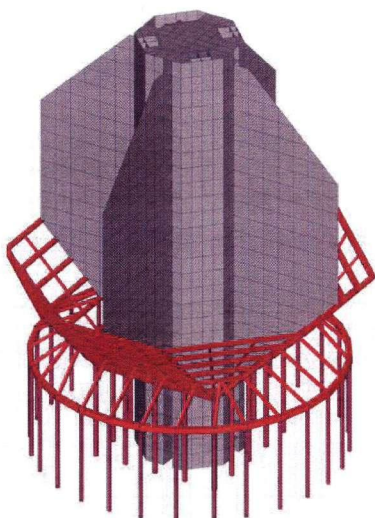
Вариант 5 конструктивной схемы здания книгохранилища (несущими элементами, воспринимающими нагрузку от элементов каркаса, являются восьмигранный железобетонный ствол с 4-мя диафрагмами, опорное кольцо с раскосами и трубобетонные колонны)
